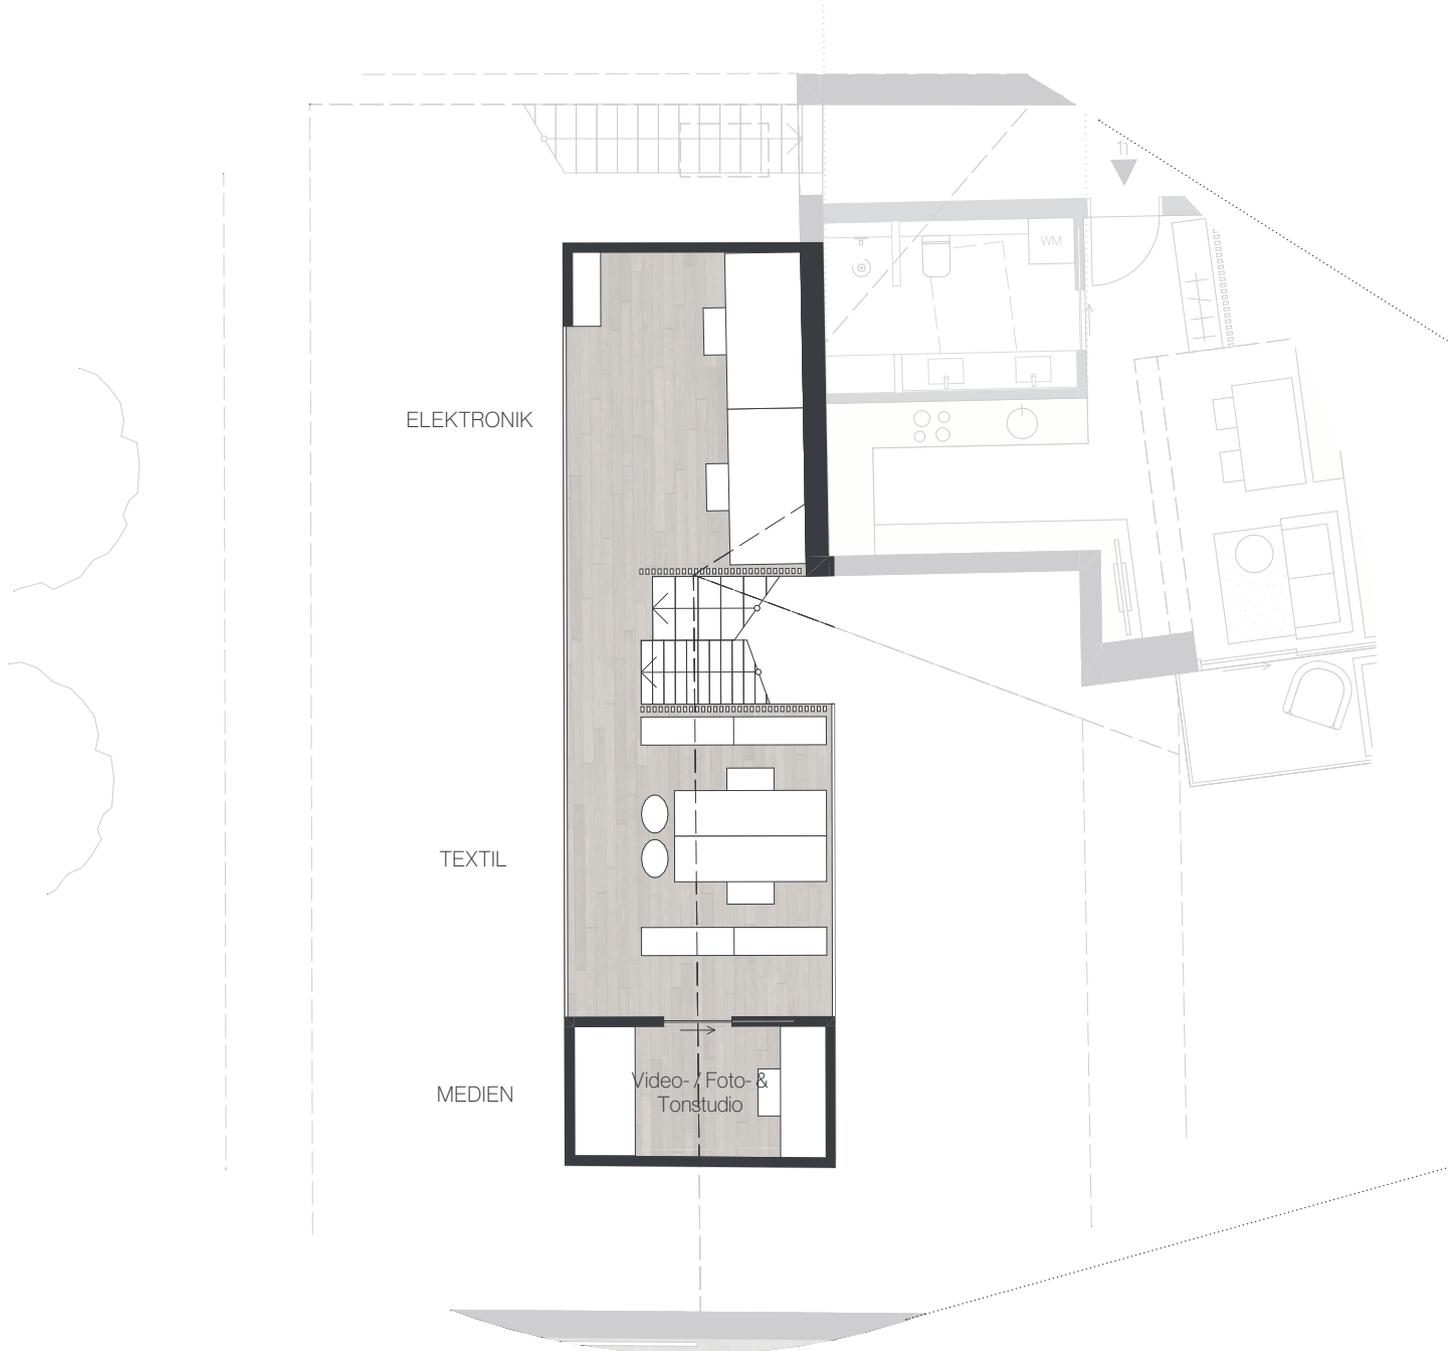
| Grundriss Erdgeschoss, Werkstätte 191
